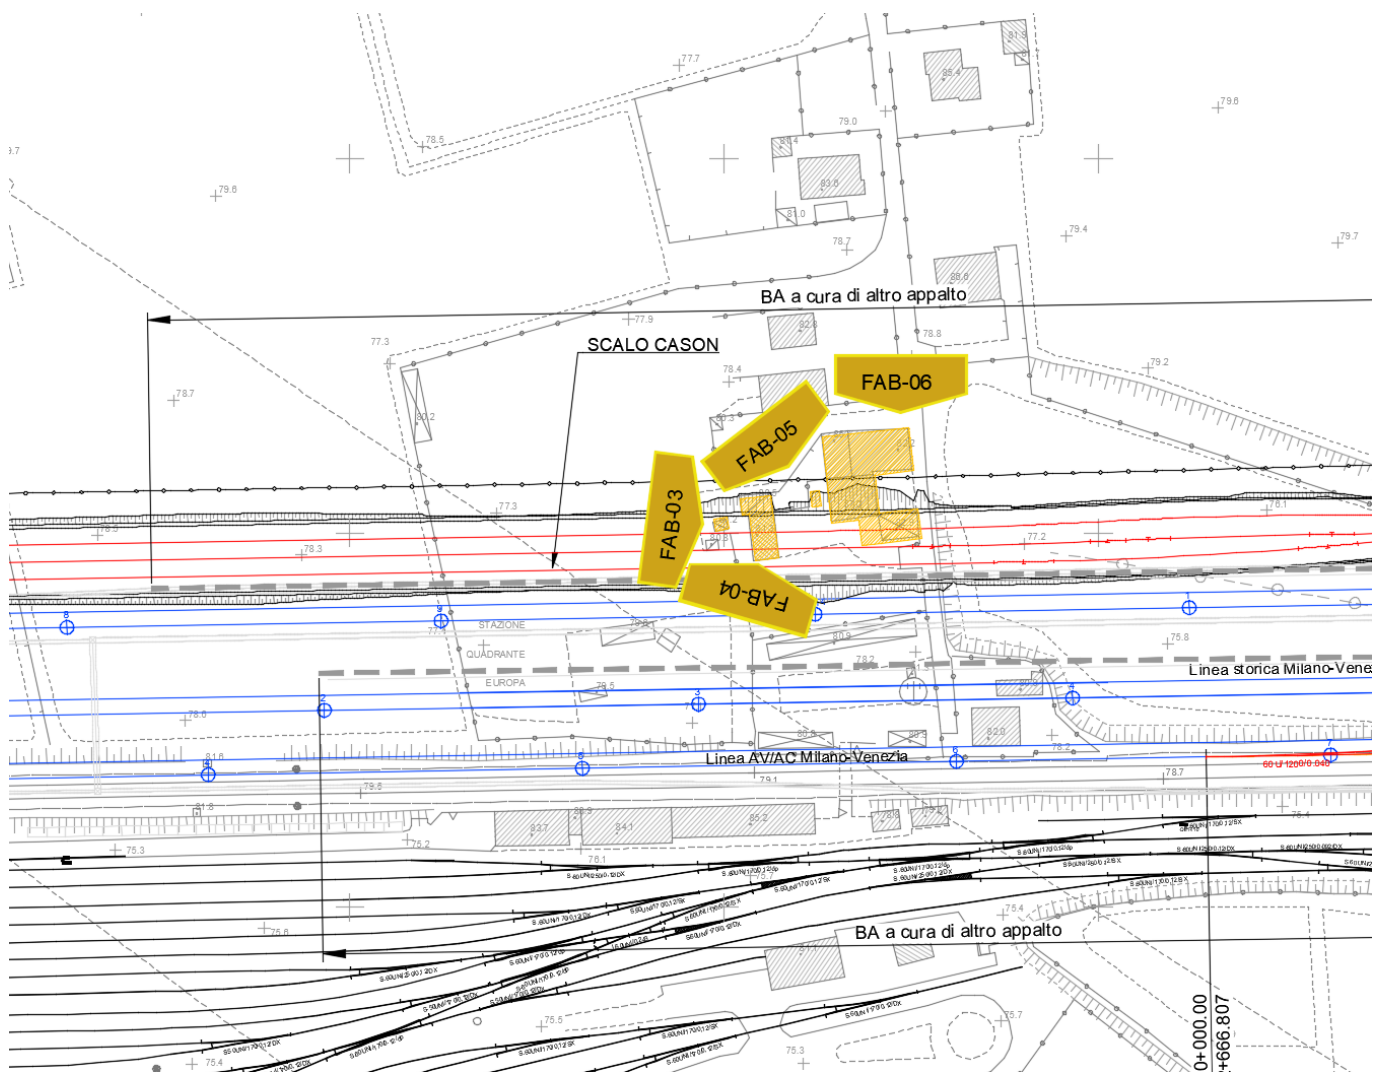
Stralcio planimetrico zona Stazione Verona Quadrante Europa
